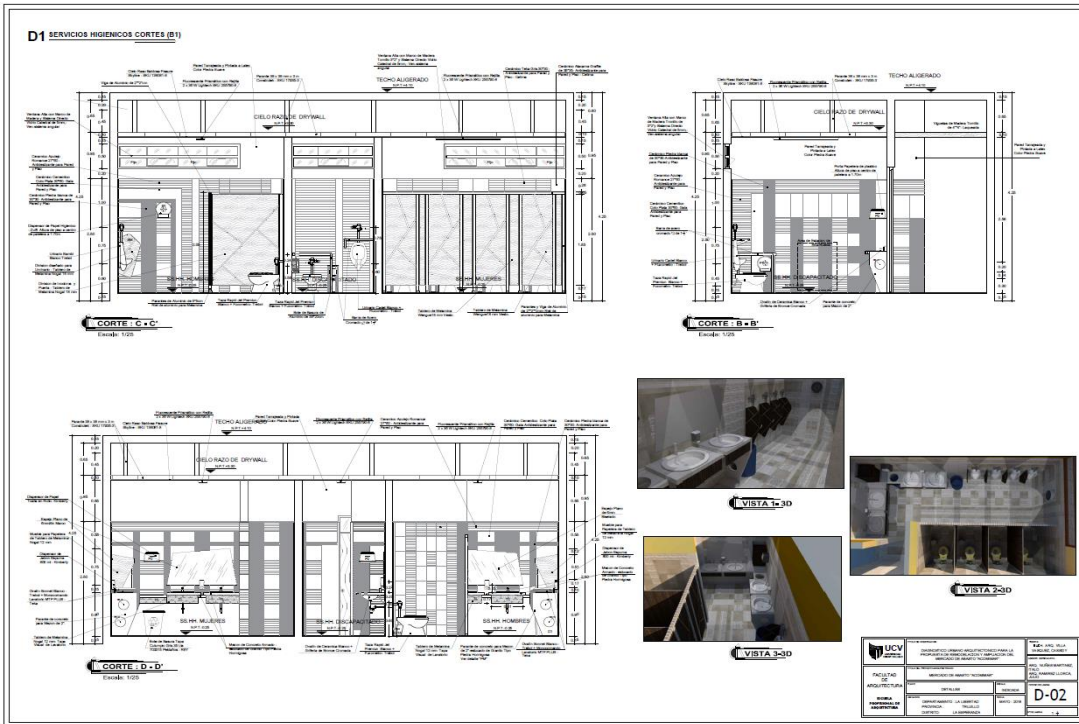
Detalle en Corte y elevación de Servicio Higiénico B1
